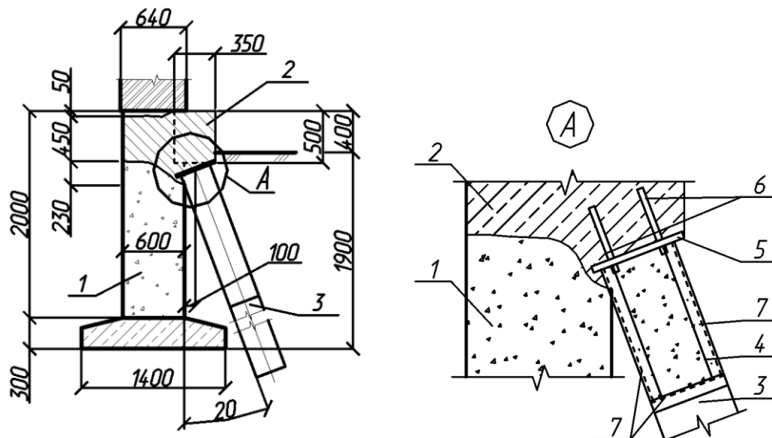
Схема усиления существующего фундамента задвливанием свай:
